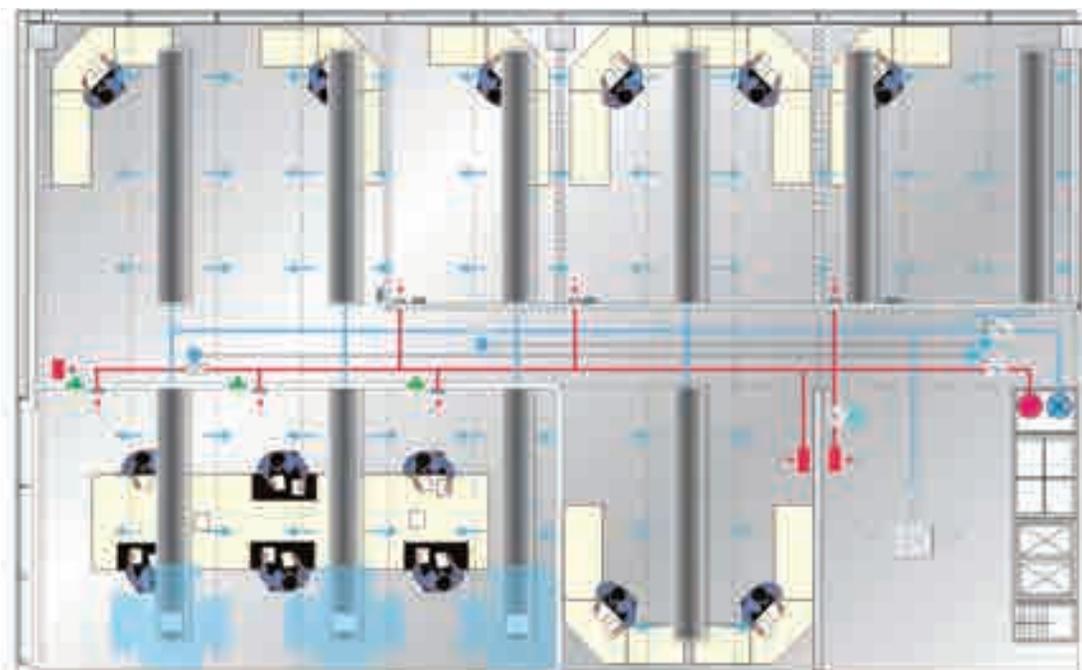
La disposizione delle travi fredde è modulare e segue il lay-out delle postazioni di lavoro.
